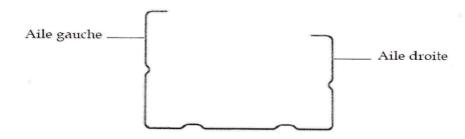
Coupe transversale d'un élément d'ossature métallique « Montant 90 »
